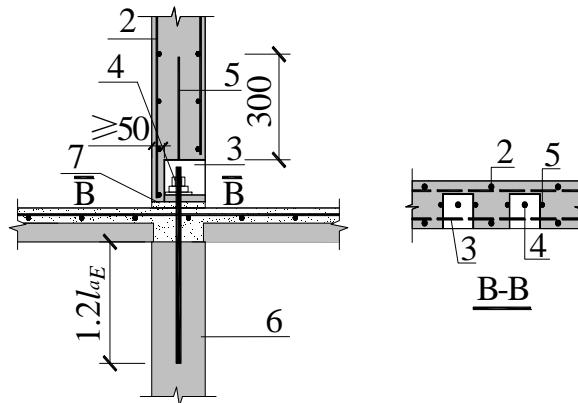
预埋连接器形式螺栓连接构造示意
